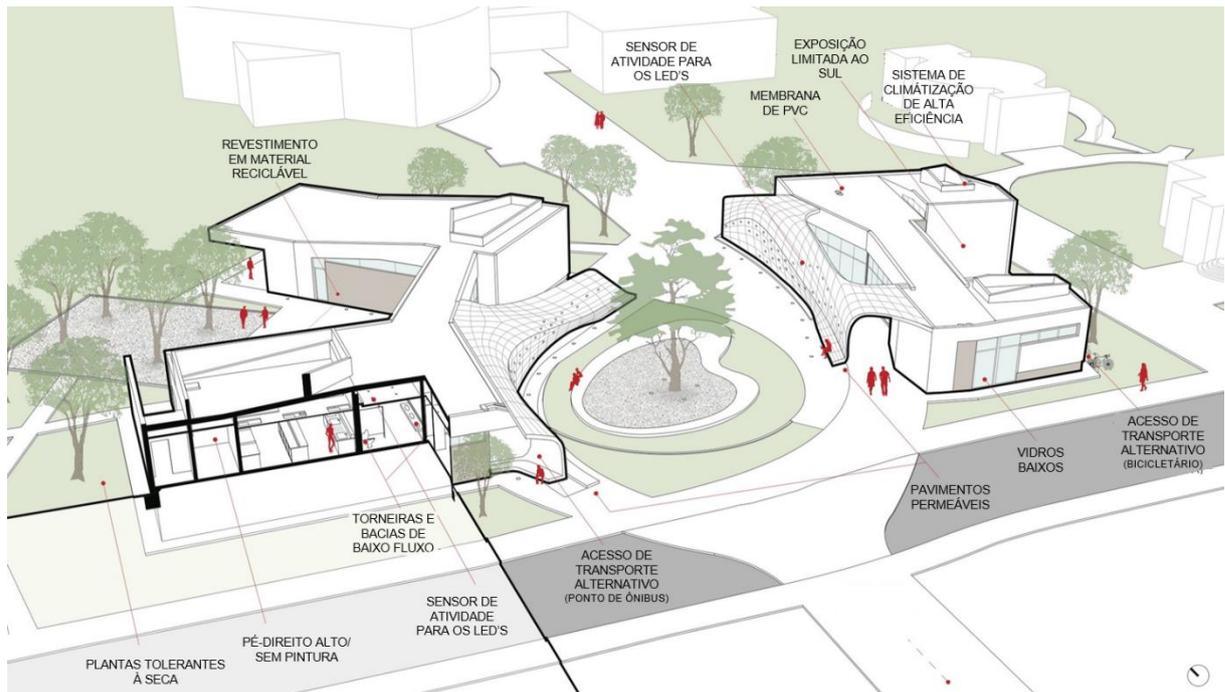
Planta baixa do projeto *Kaplan Family Pavilion*.
